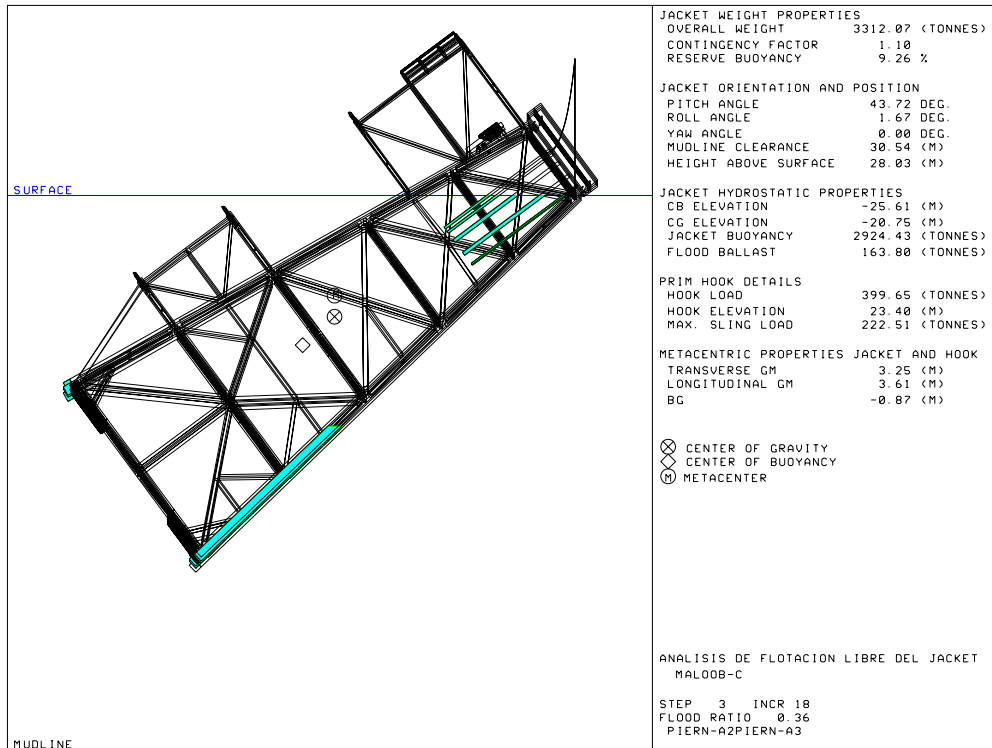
Posición de la estructura para una elevación del gancho de 23.40 m.
